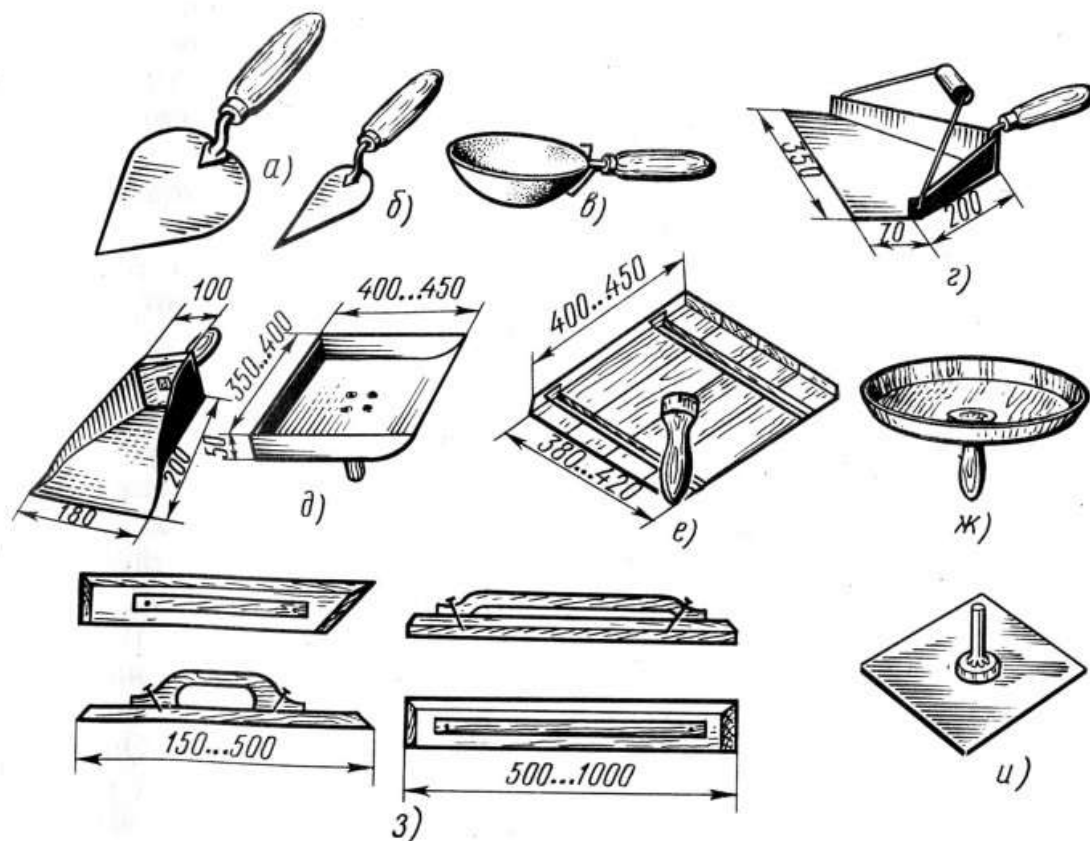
Инструменты для нанесения и разравнивания раствора: а – штукатурная кельма; б – отрезовка; в – ковш; г – совок с качающейся ручкой; д – совок-лопата и сокол-ковш; е – прямоугольный сокол; ж – тарельчатый сокол, з – полутерки; и – разборный дюралюминиевый сокол
